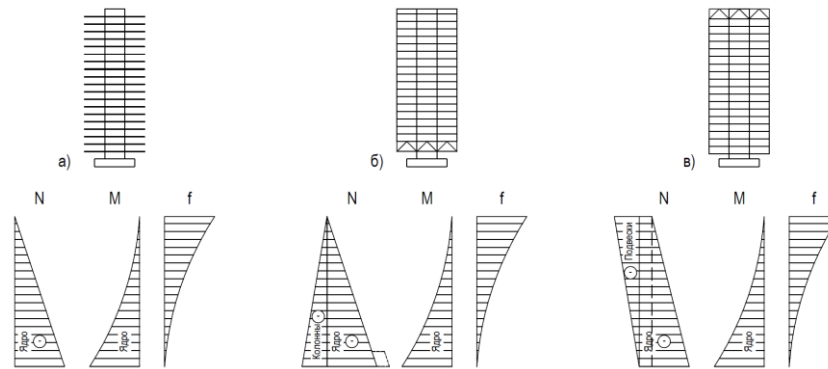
Эпюры нормальных сил N , изгибающих моментов M и горизонтальные прогибы f для ствольных систем: а) с консольными конструкциями перекрытий; б) с перекрытиями, опирающимися на консольную платформу в уровне нижних этажей; в) с перекрытиями, подвешенными к консольному оголовку в уровне верхних этажей
